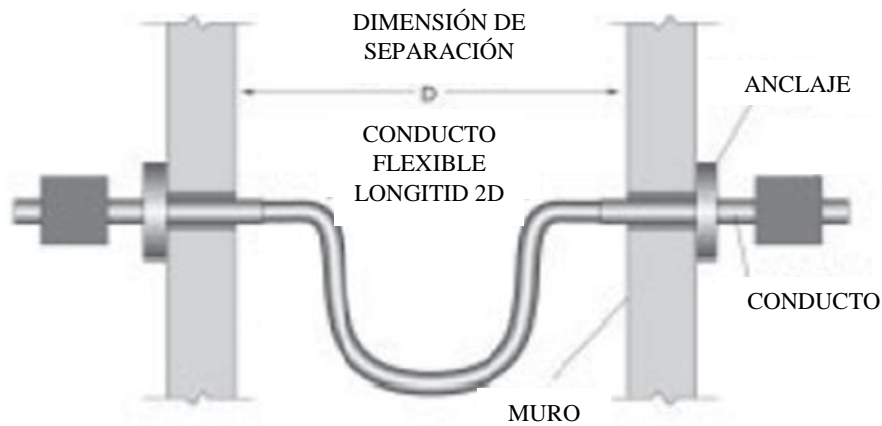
Conexión flexible que atraviesa la junta sísmica (FEMA 413).
